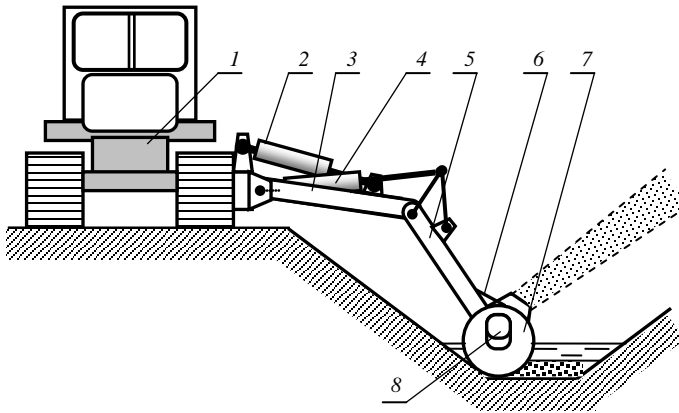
Схема работы каналоочистителя с фрезерным рабочим органом: 1 – трактор; 2, 4 – гидроцилиндры; 3 – рама; 5 – рукоять; 6 – тяга; 7 – рабочий орган; 8 – гидромотор
